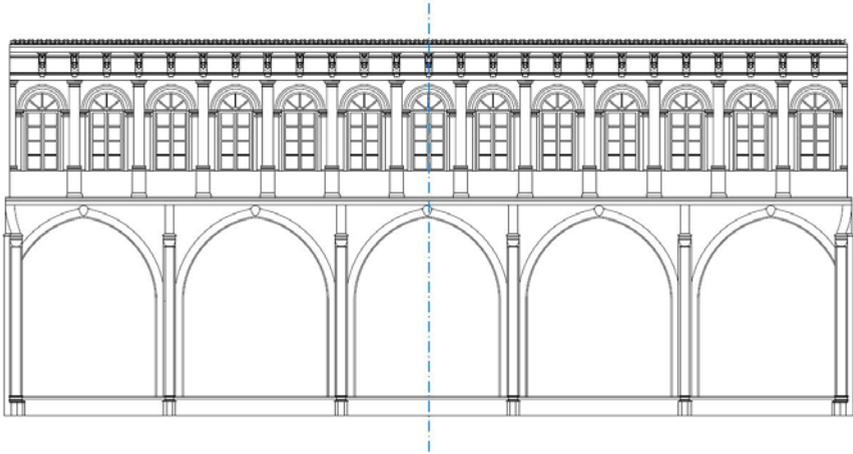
Alzado Norte del Claustro Mayor. 2016. Plano del autor.
